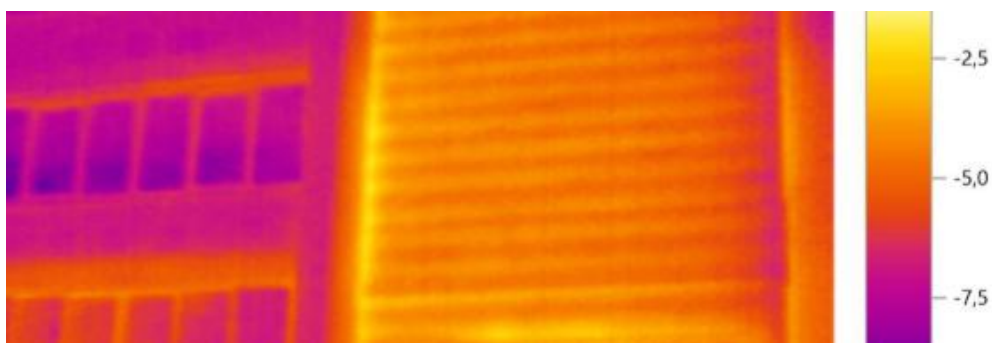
Тепловизионная съемка стен здания, отражающая потери тепла через армированные участки стен
